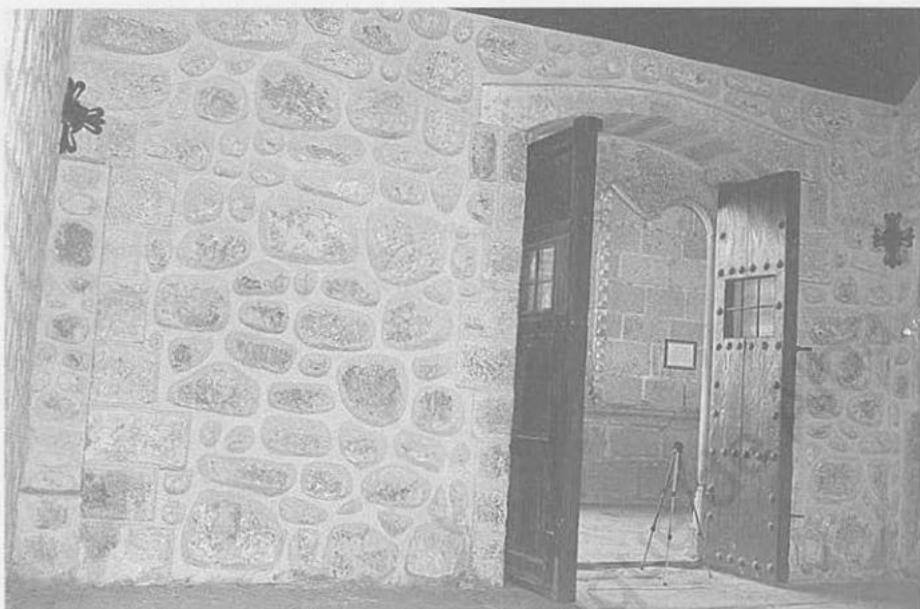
Claustro del Silencio. Panda este. Piso inferior. De Profundis. Muro este-lado oeste.
